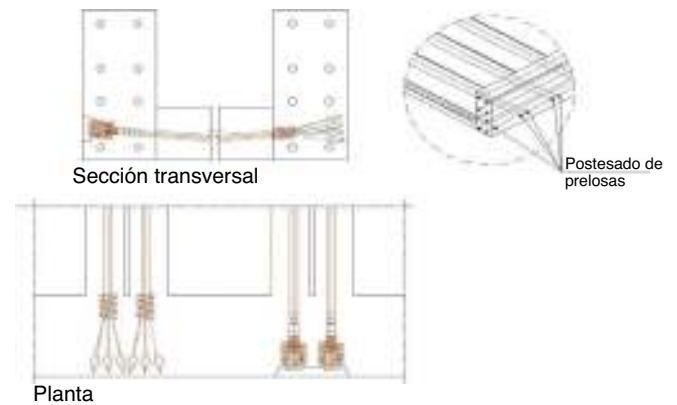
Postesado transversal de las piezas en pi; a la izquierda, el anclaje pasivo; a la derecha, el anclaje activo.
